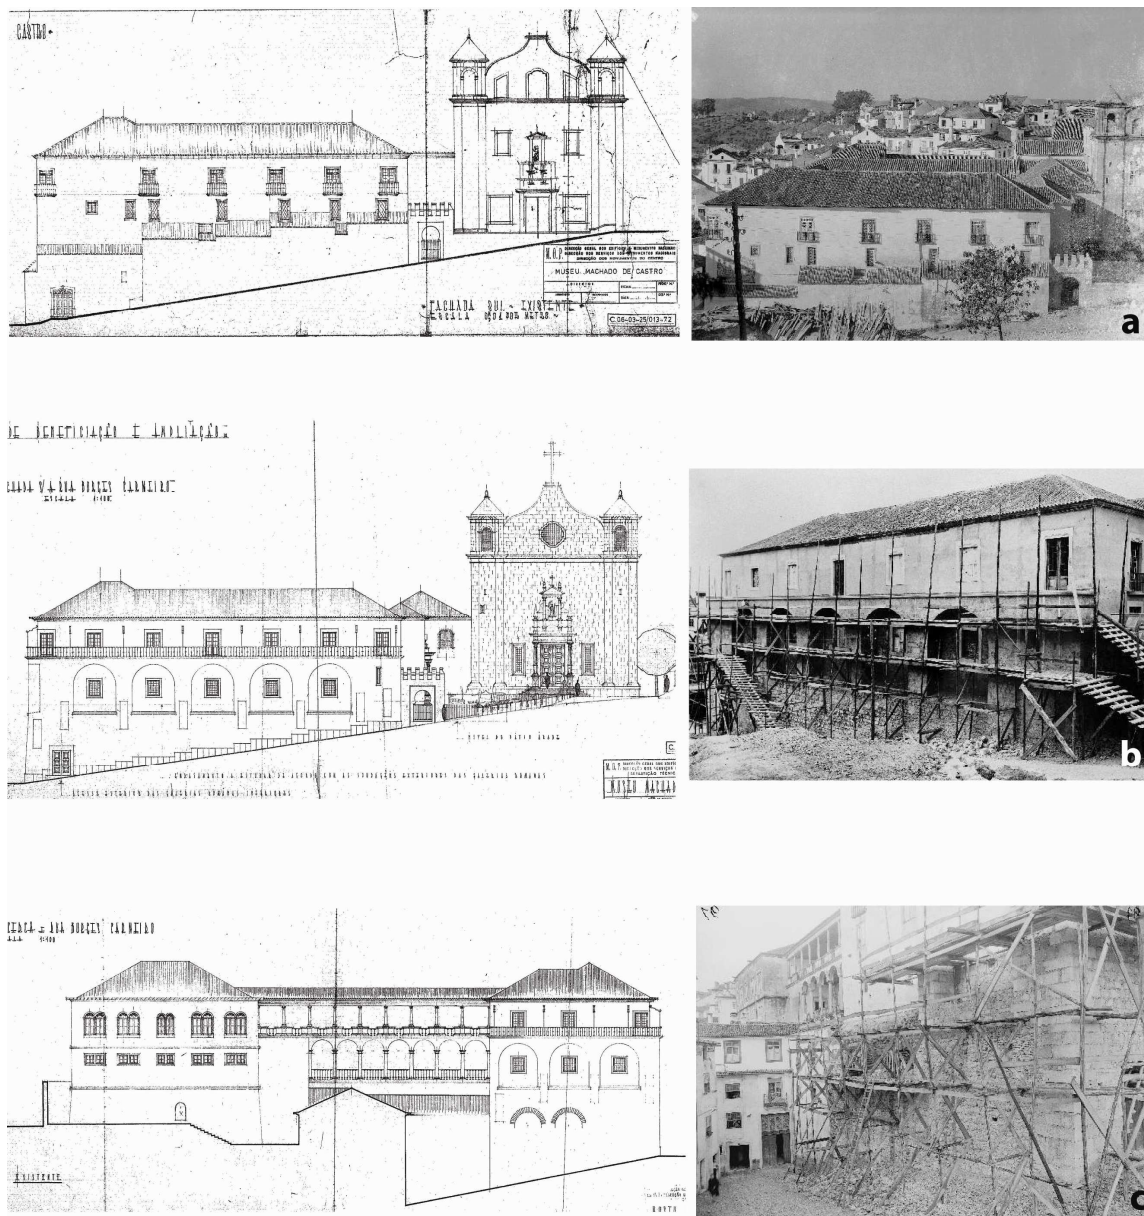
a-b: fachada sul do museu (antes (a) e durante a sua reestruturação (b) em 1945); c: fachada poente (zona sul) durante os trabalhos de reestruturação de 1945 (casas anexas ao fundo). (Arquivo da DGEMN)
